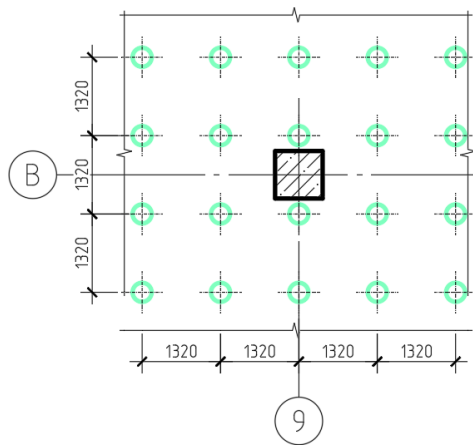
Схема расположения свай под фрагмент плитного фундамента
